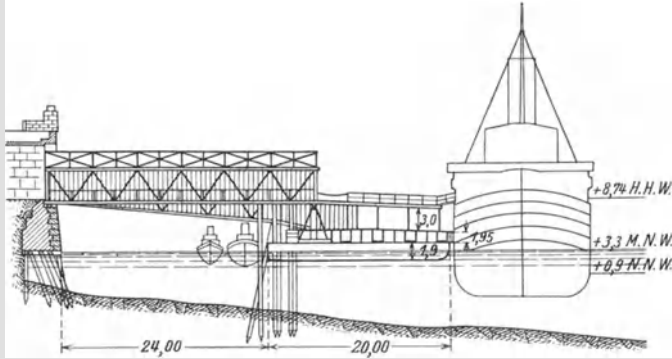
St. Pauli-Landungsbrücke. Querschnitt. Maßstab 1 : 850.
